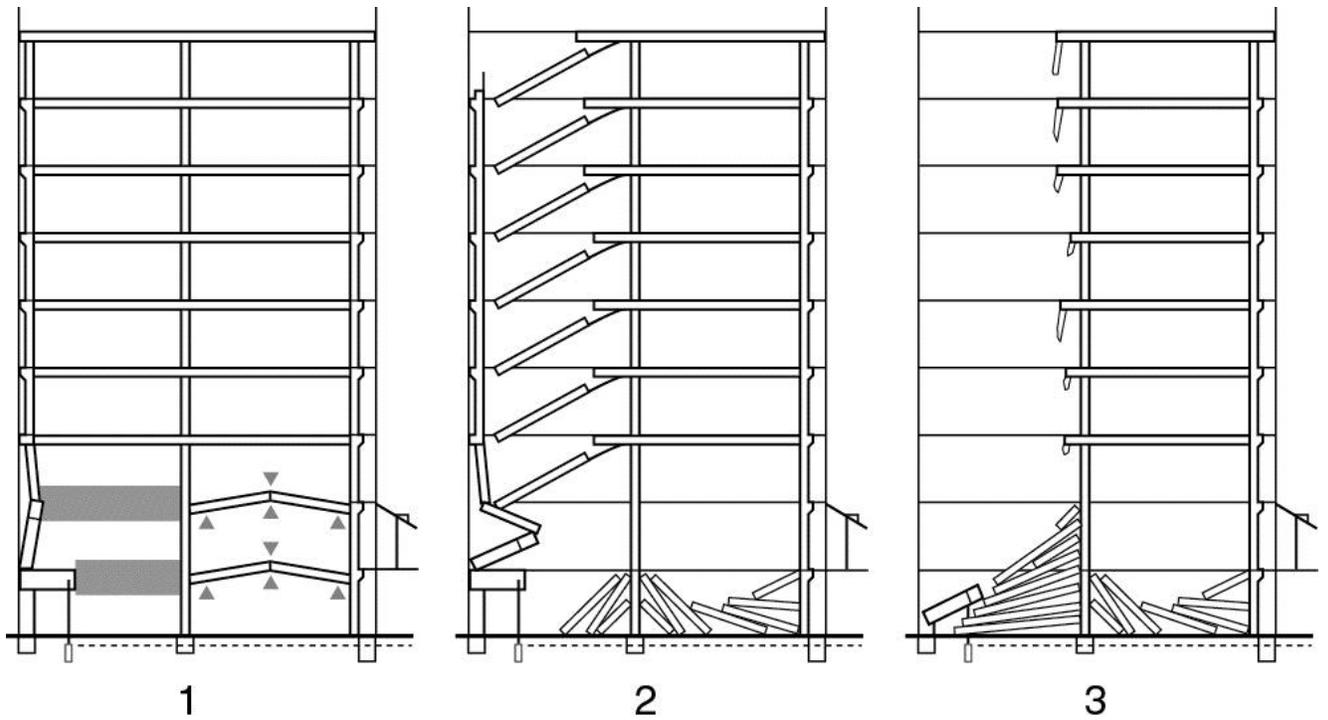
(j) Fuego Agotamiento del modelo de colapso - Techo / Suelo Burn-Out - pared gruesa Construcción - URM o Tilt-Up.
